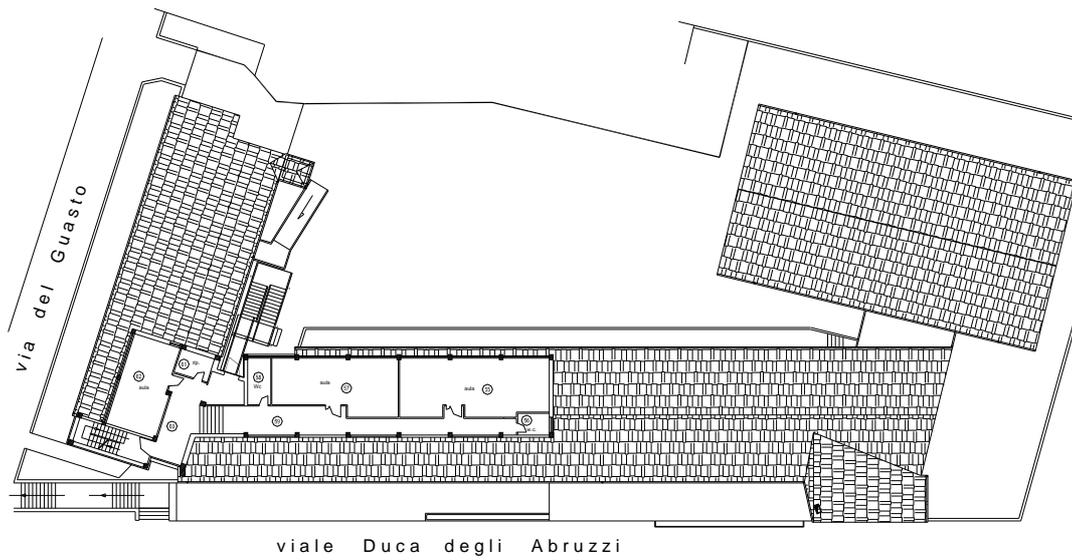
Pianta Piano Terzo (aule scolastiche).
